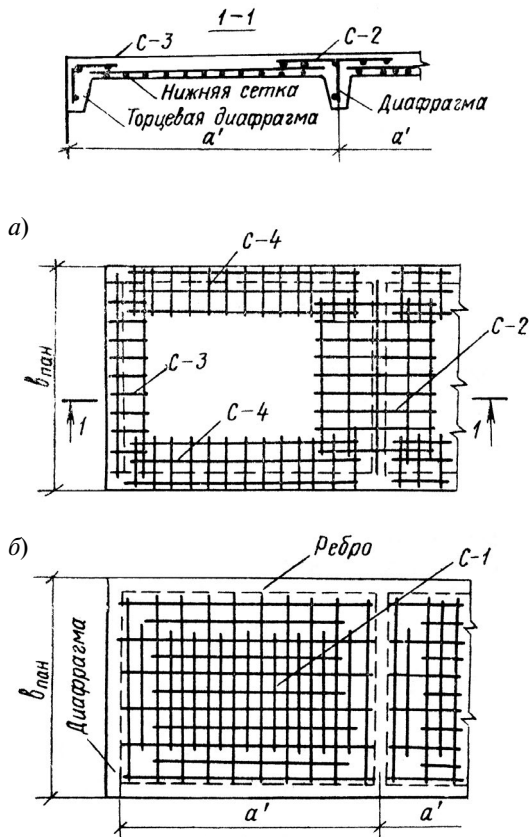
Схема армирования участка плиты панели: а — план верхней арматуры; б — план нижней арматуры
